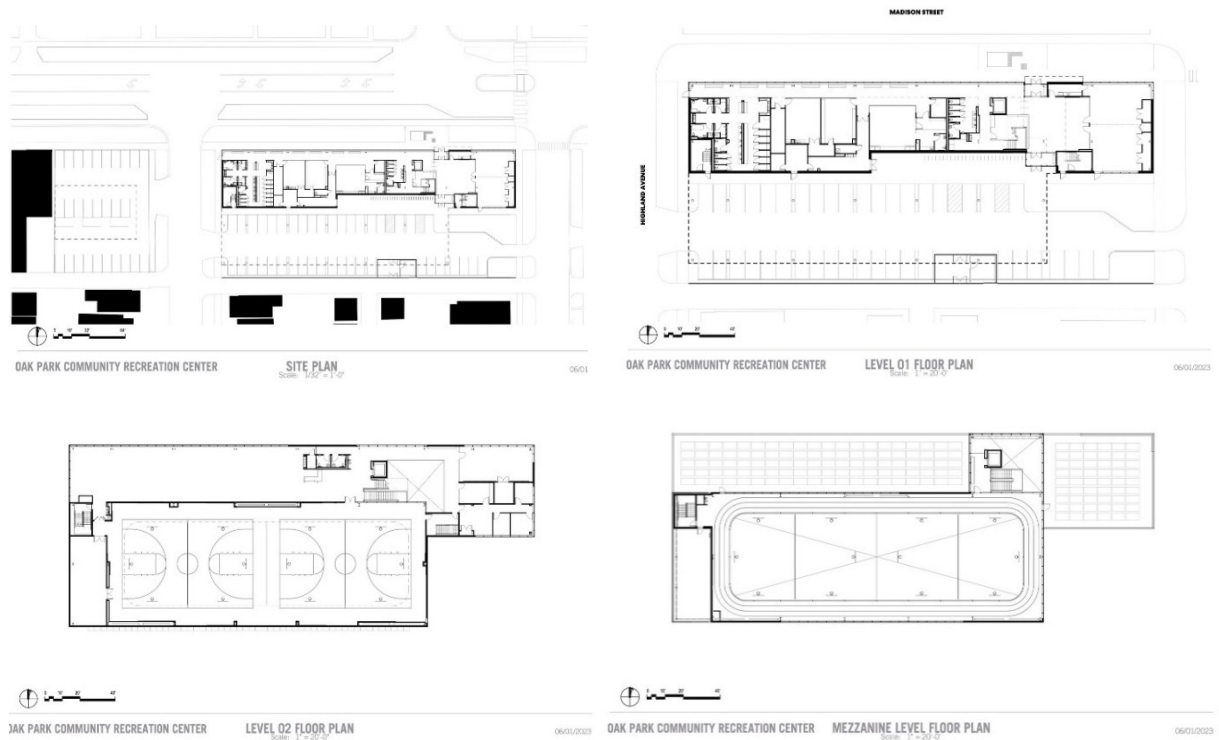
Генплан та плани поверхів 1-3 [2]
